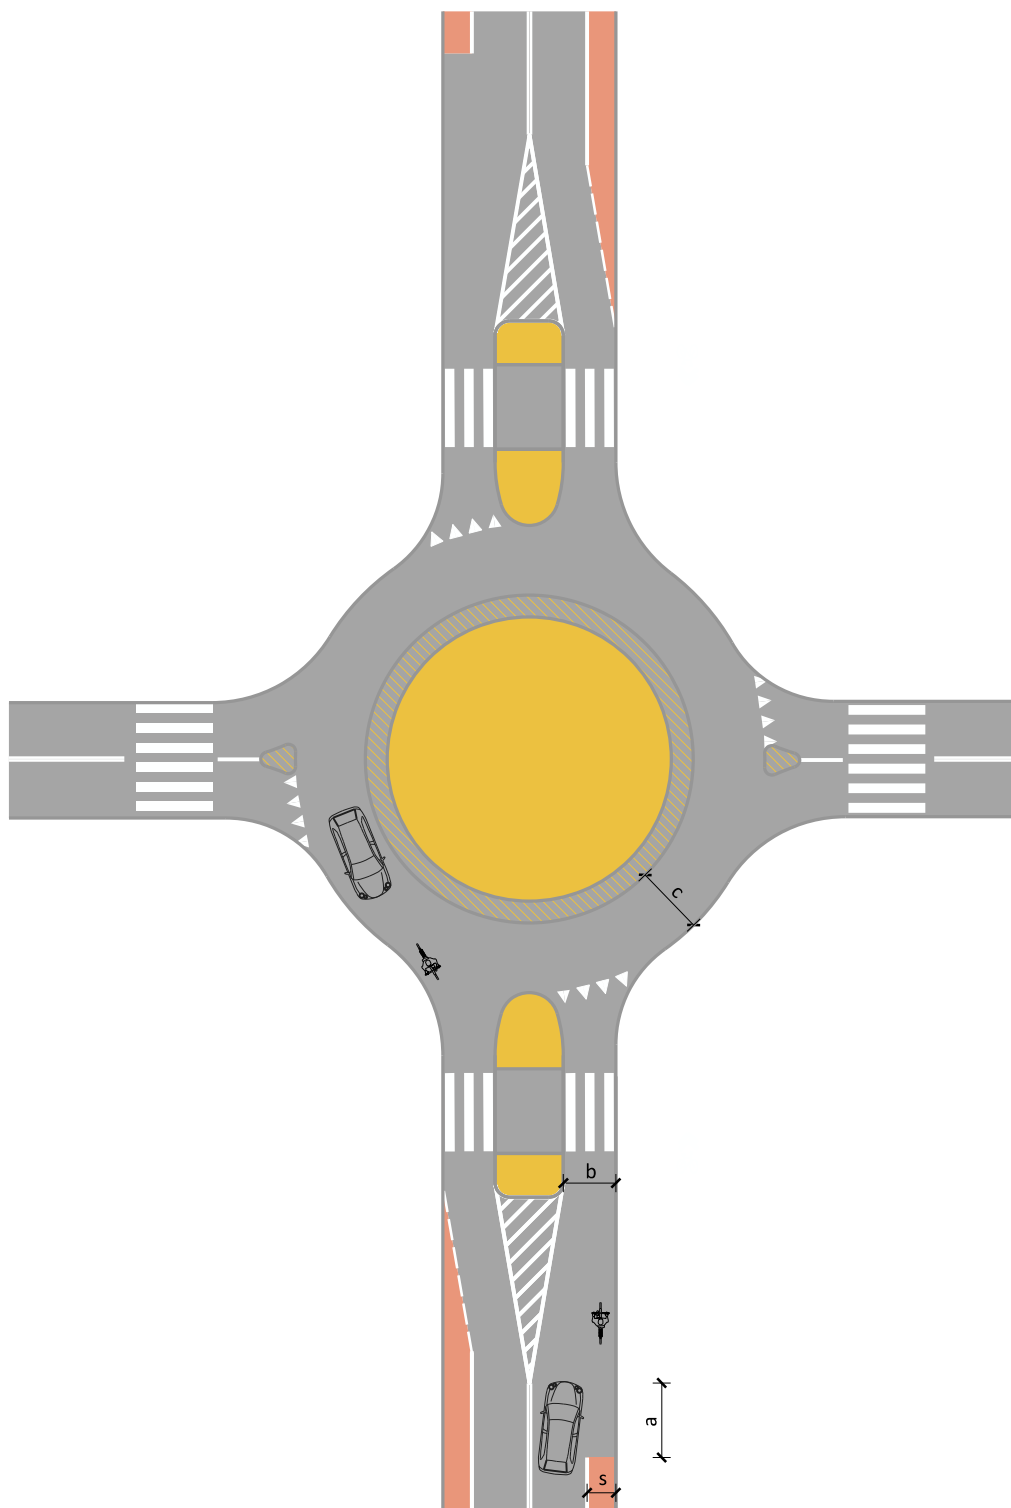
Schemat skrzyżowania zwykłego ulicy jednokierunkowej z kontrapasem ruchu dla rowerów z ulicami jednokierunkowymi (np. jezdniami ronda)
